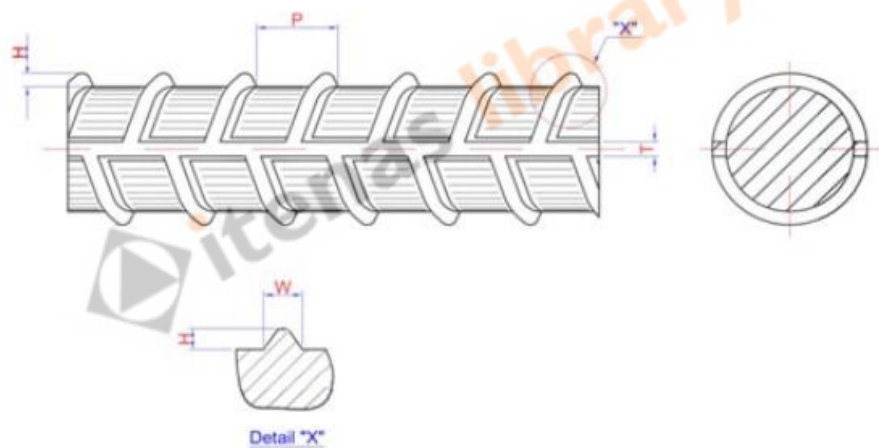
2 Baja Tulangan Beton Sirip/Ulir Bambu
